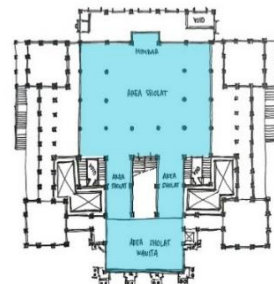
Denah Eksisting Masjid Al-Aqsha Klaten Lantai 3
